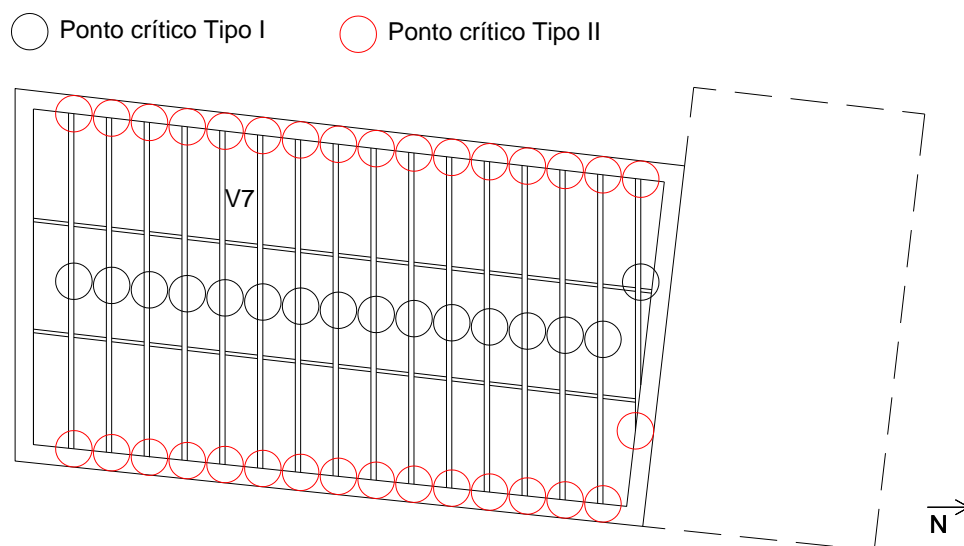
Pontos críticos dos elementos estruturais de madeira do pavimento do rés-do-chão
